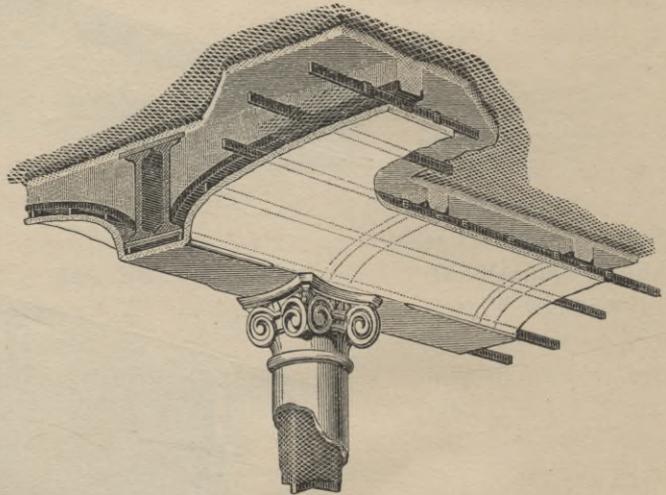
Cassettierte Decke mit Streckmetallbeton.
